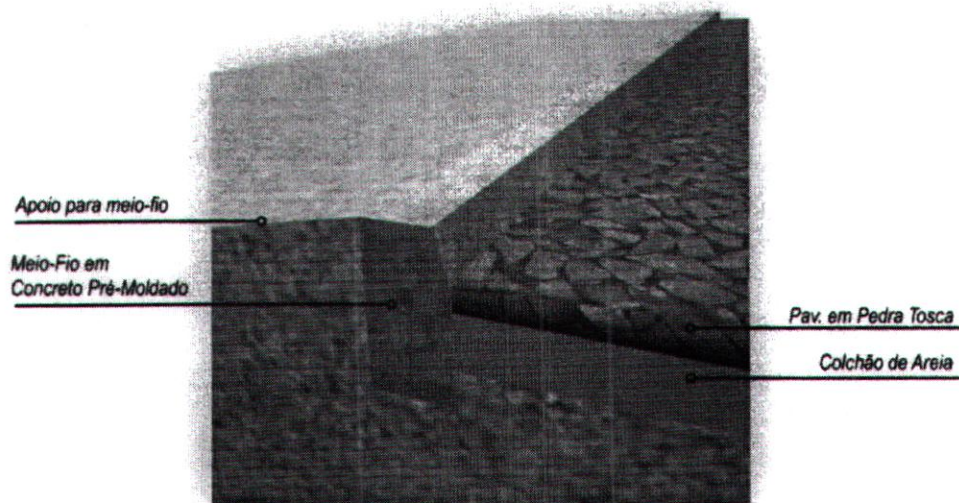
Detalhe construtivo de Pavimentação em Pedra Tosca
